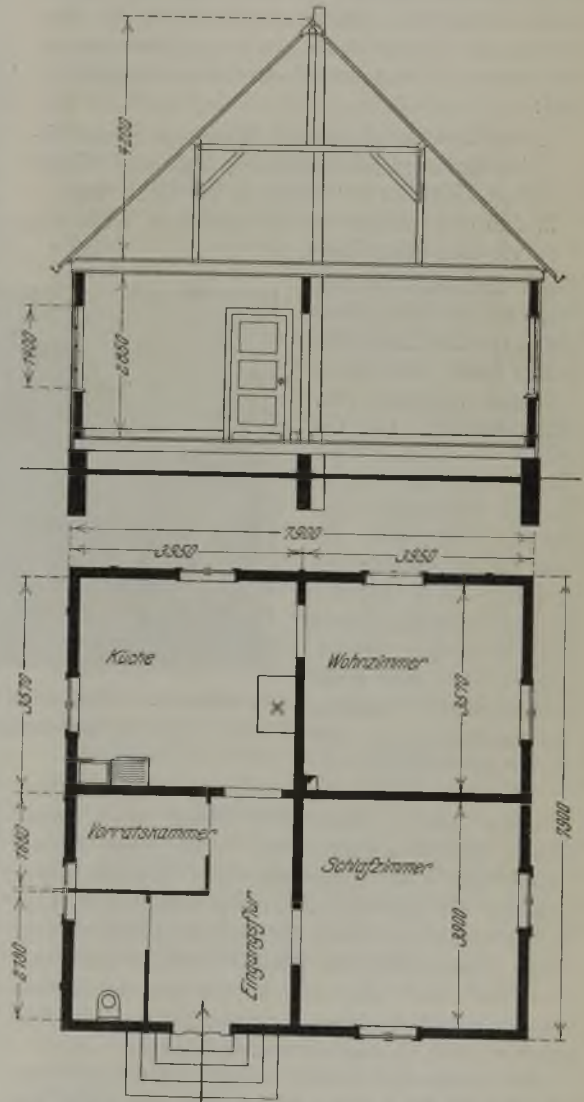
Aufriß und Grundriß des Stahlhauses.
